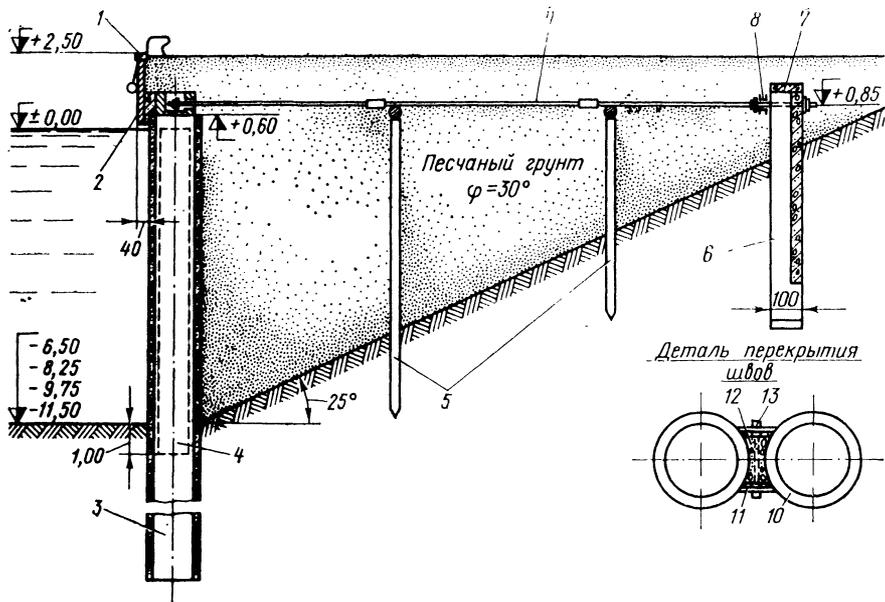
Больверк из железобетонных оболочек для строительства в морских условиях:
